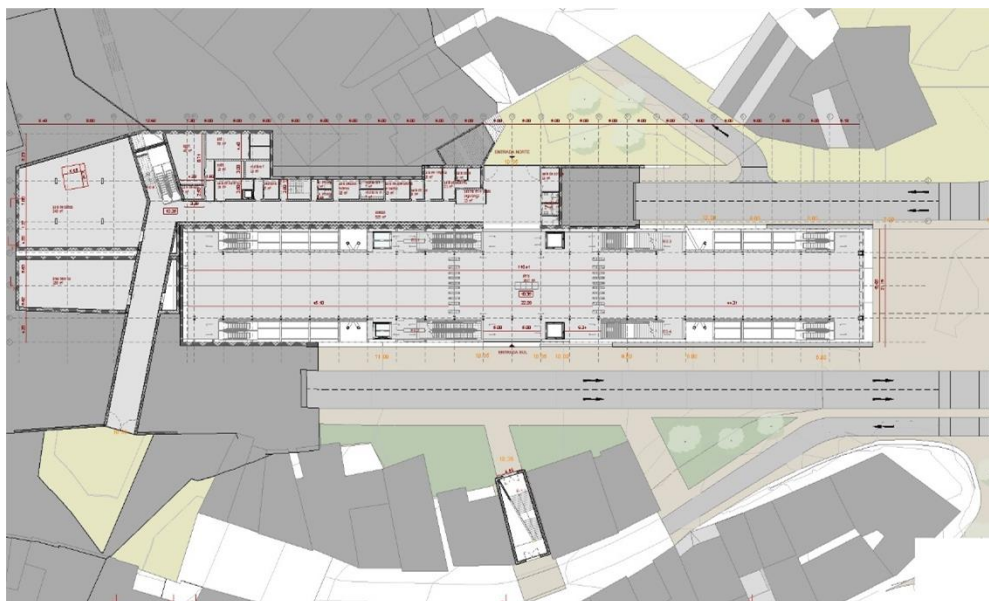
Planta Piso 0 - Átrio (ML 134352).
